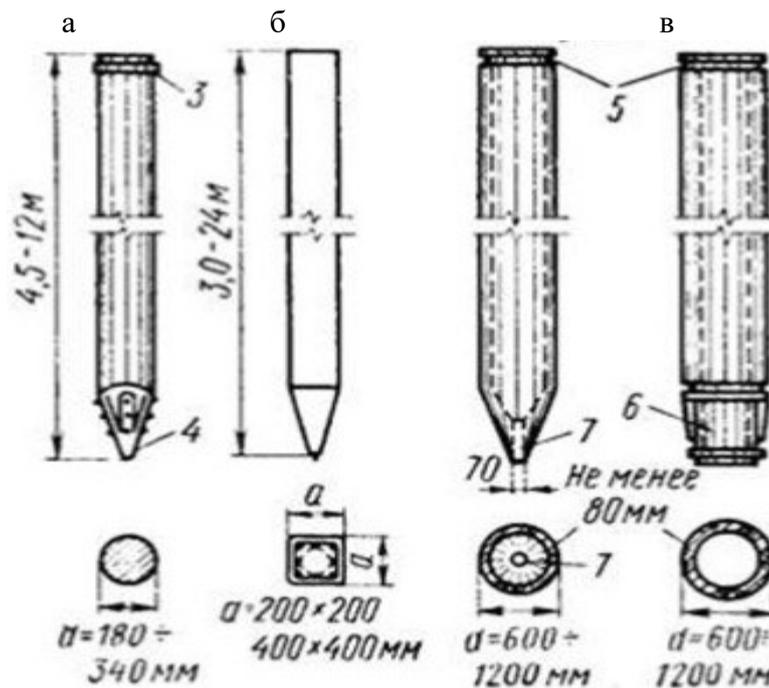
Виды забивных свай: а – деревянные, б – железобетонные сплошного сечения, в – железобетонные трубчатые; 4- стальной башмак, 5 – стальной фланец, приваренный к арматуре сваи, 6 – стальной наконечник, 7 – отверстие.
